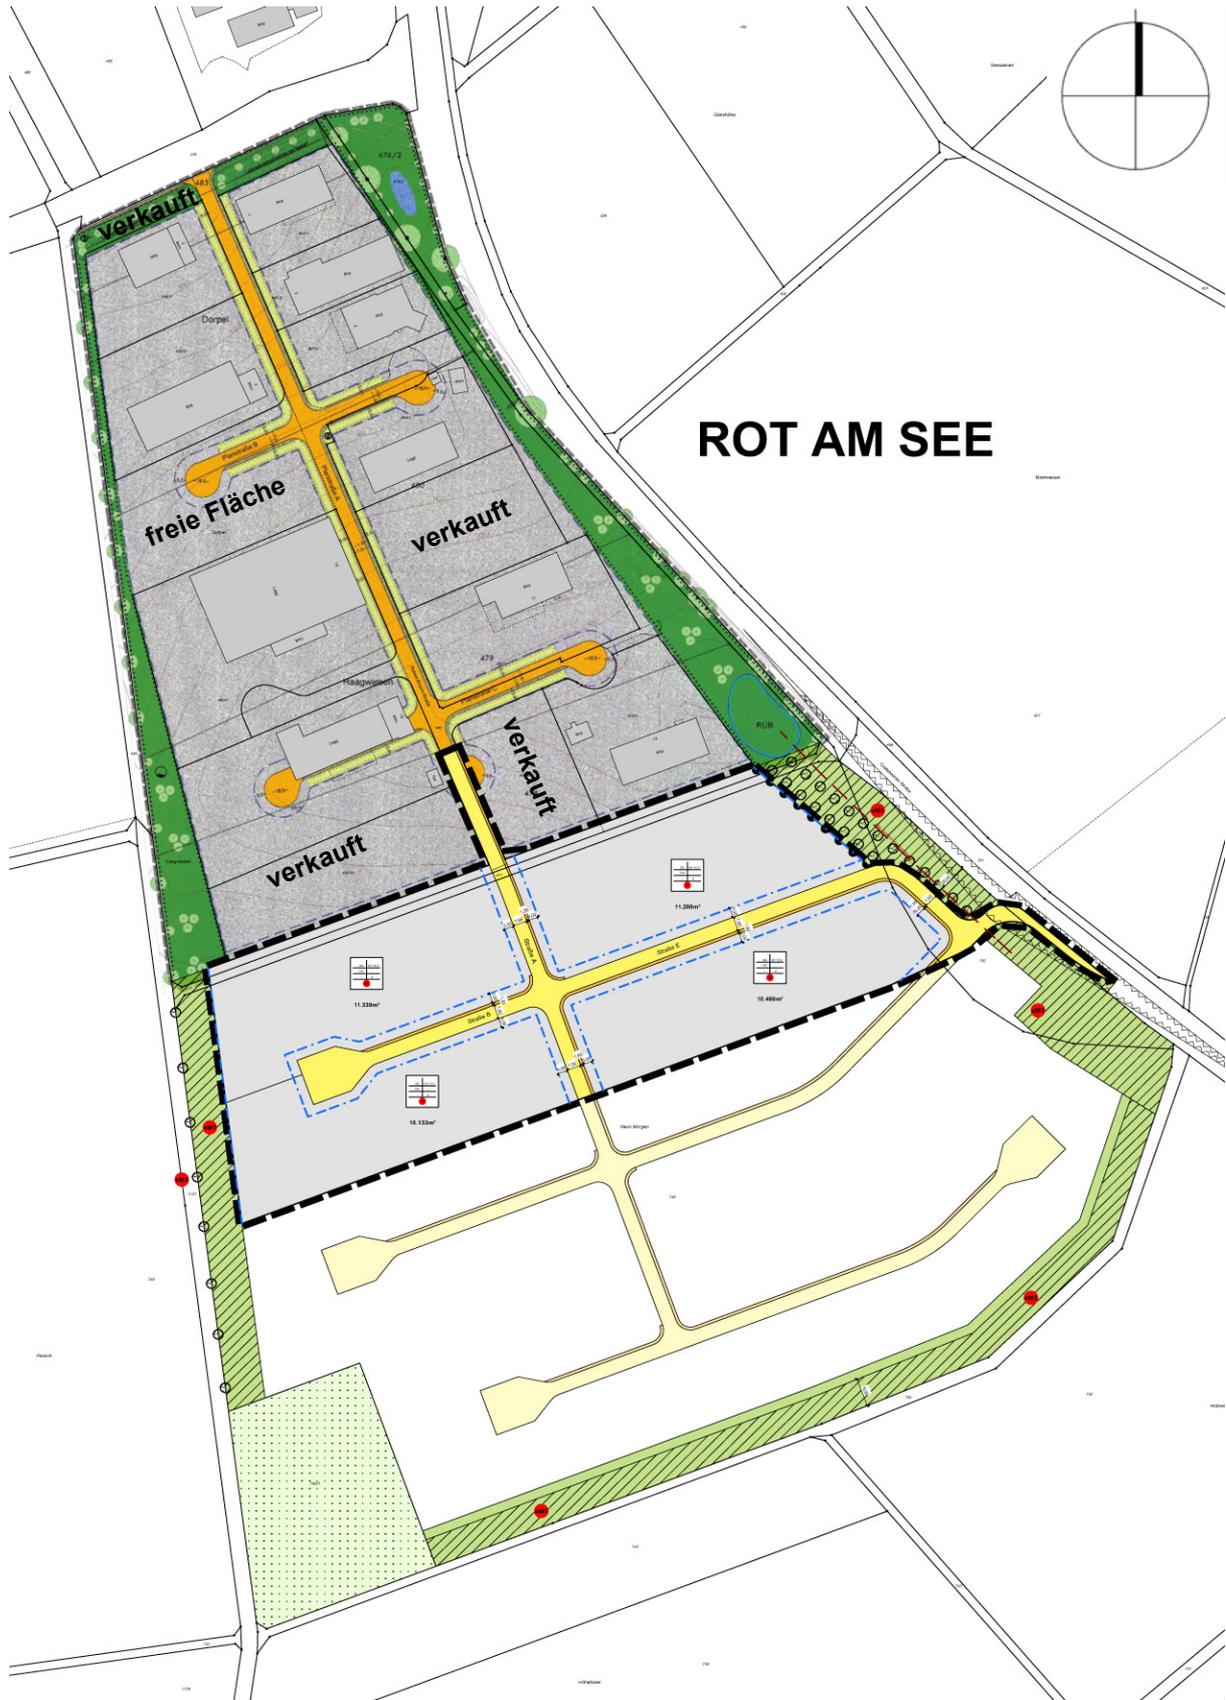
Bestehende Bebauung sowie Erweiterungsfläche, 1:4.000
